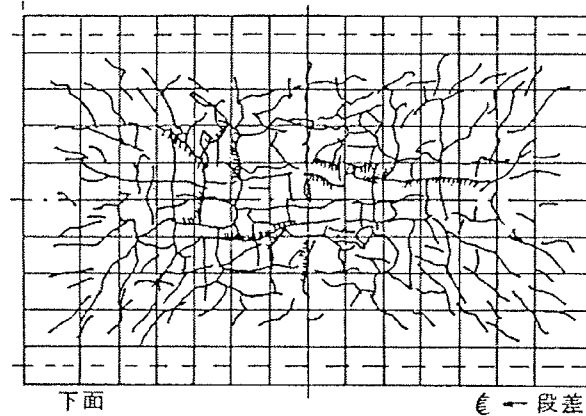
床版下面ひび割れ状況(DR-1)
